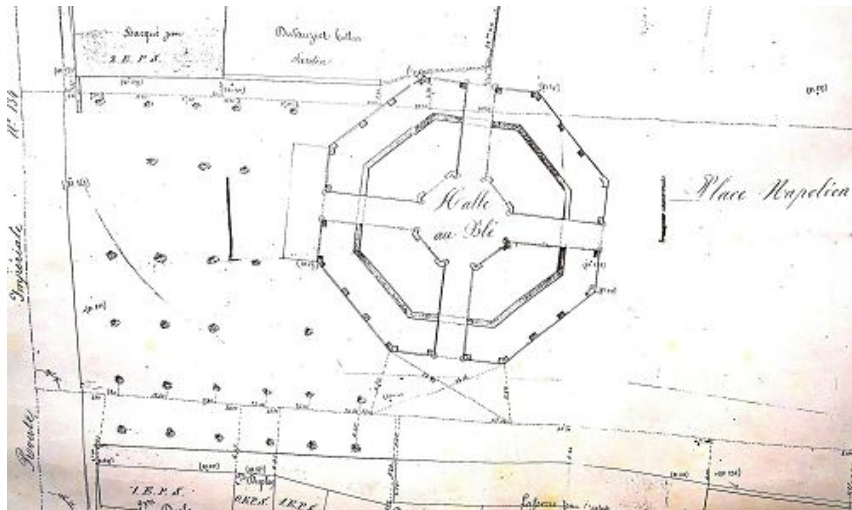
Plan général sur la place Napoléon. Arch. mun. Aire - 3 M 21
